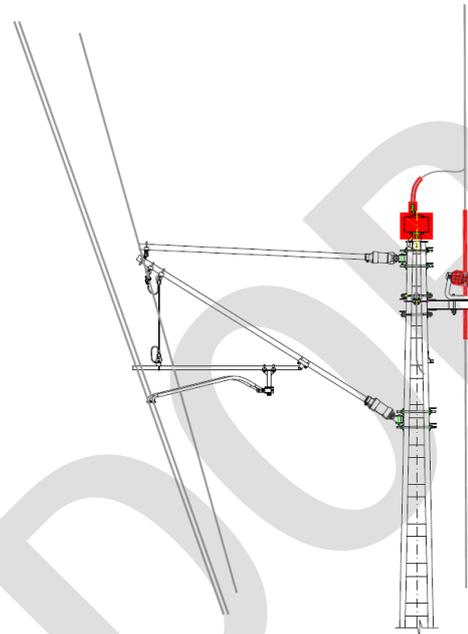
Autoválvula en cabeza de poste y conjunto de suspensión de fíder.
